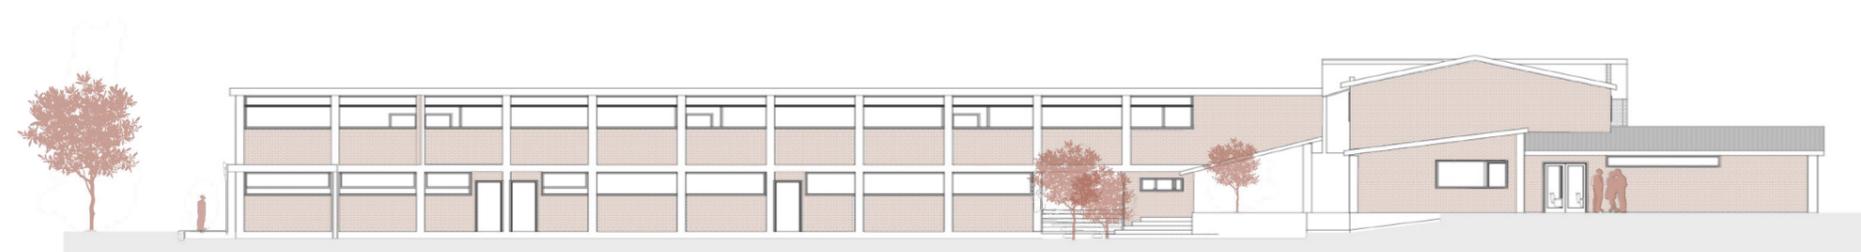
Alzado del Bloque B3 y el edificio de Administración, lugar a intervenir.
